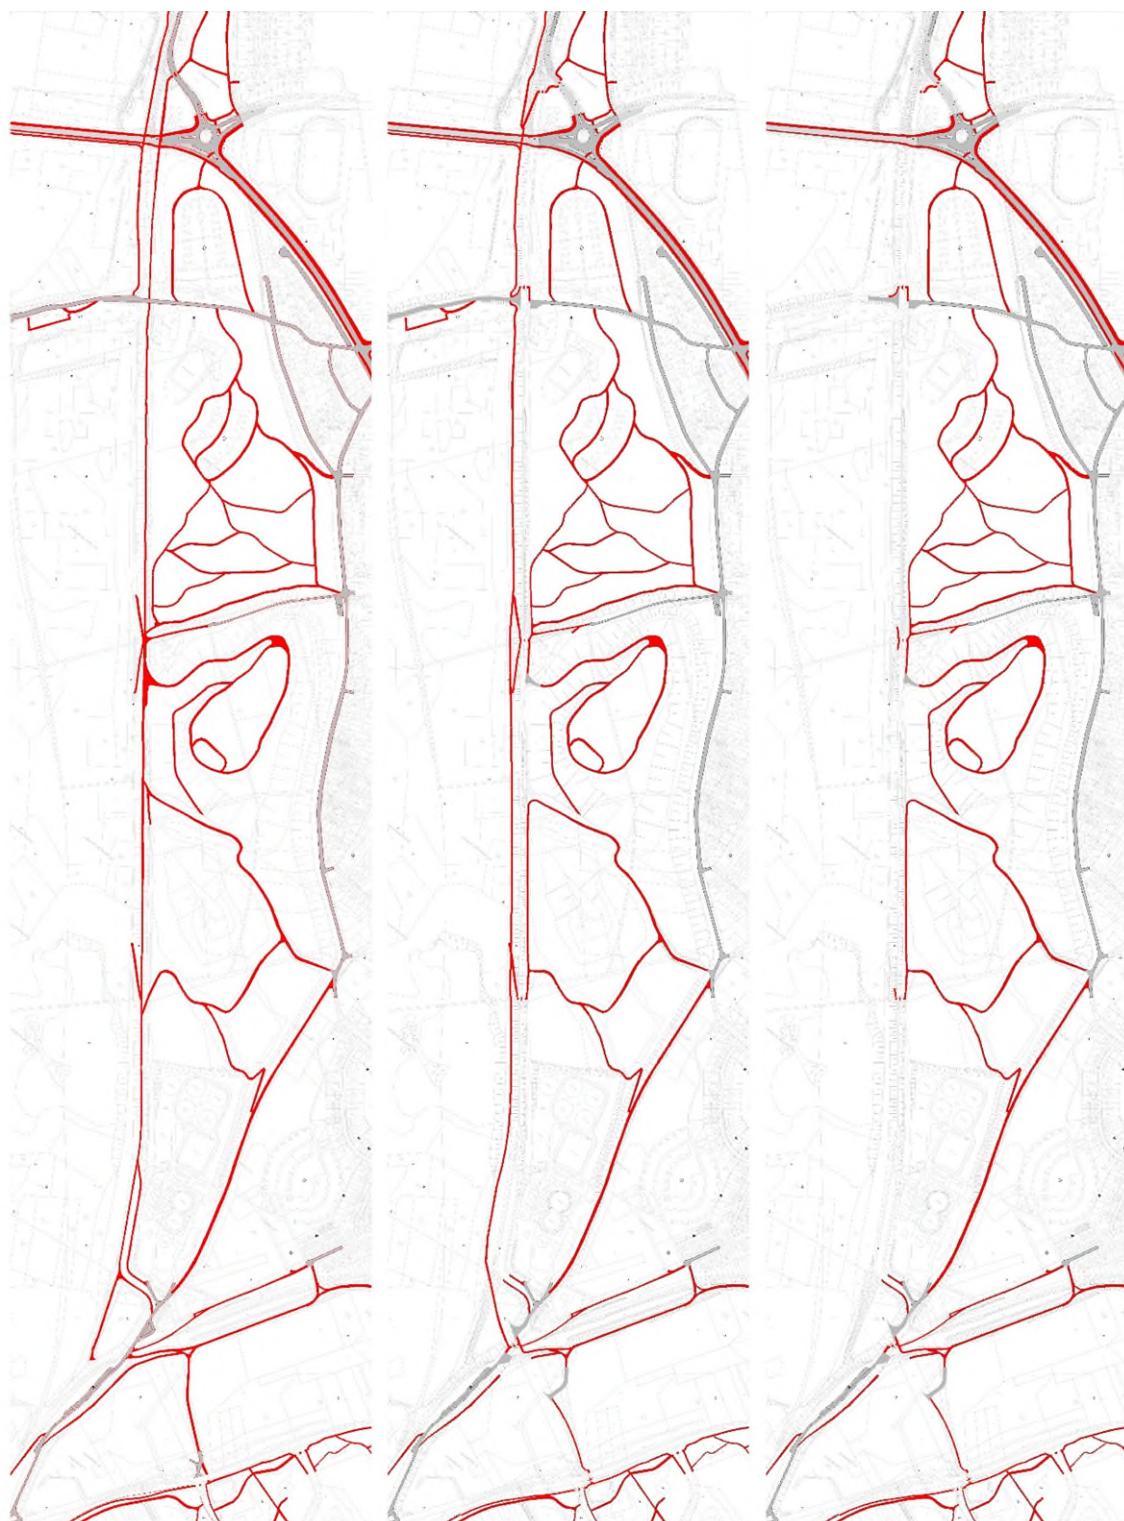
Gehwegenetz (von links nach rechts) - Bestand / Planung ohne Hochwasser / Planung bei Hochwasser > HQ 1
